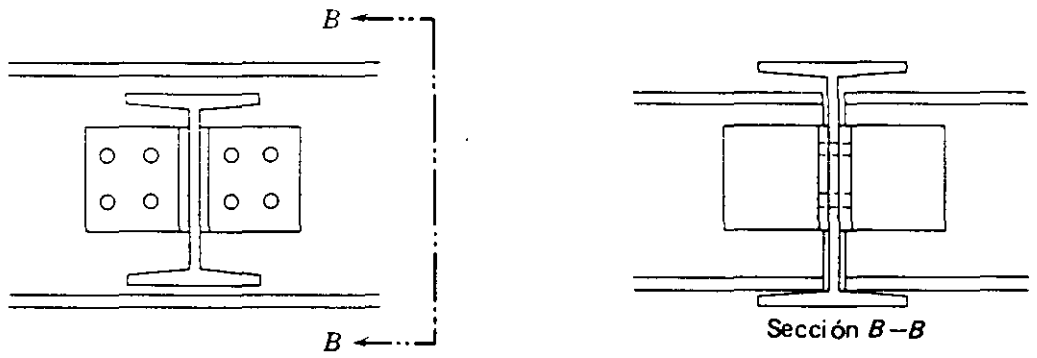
Angulos de conexión en vigas secundarias.
